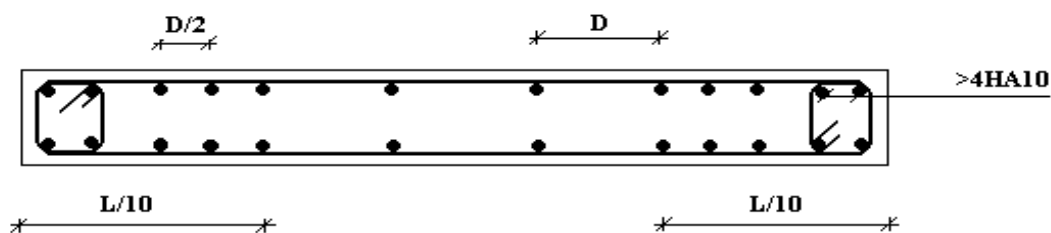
Disposition des Armatures verticales dans les voiles
